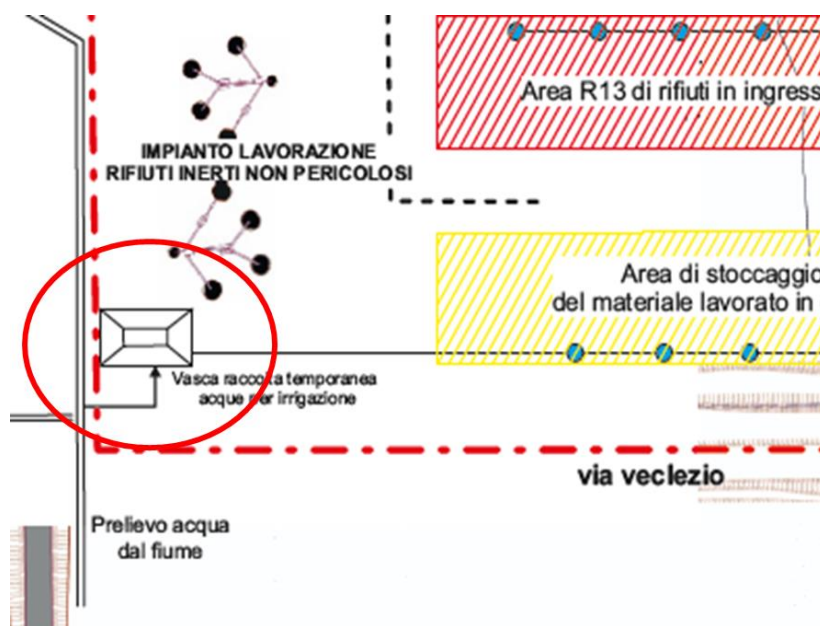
Stralcio della planimetria di progetto con evidenza della vasca di raccolta temporanea
